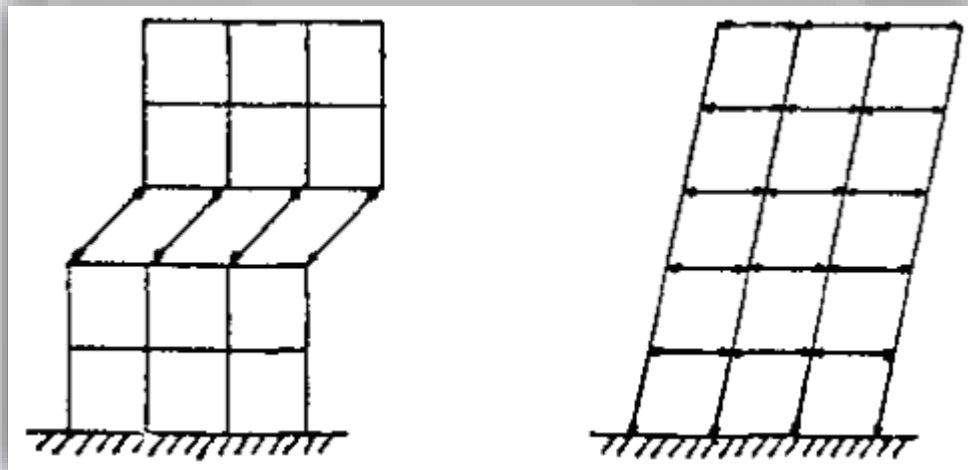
Mecanismo de falla en Columnas y en vigas.
